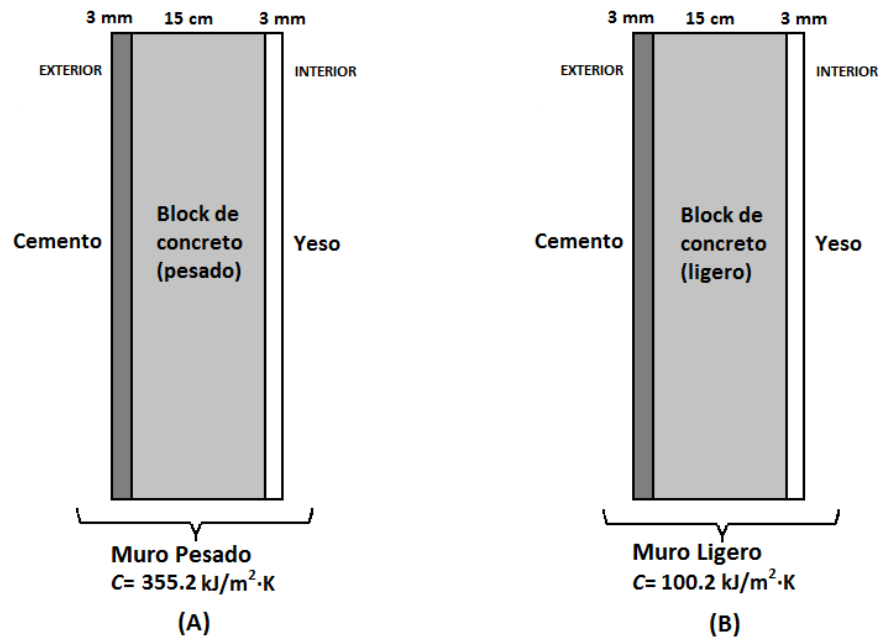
Representación esquemática de los tipos de muros utilizados en el estudio. (A): Muro de block de concreto “pesado”. (B): Muro de block de concreto “ligero”.
